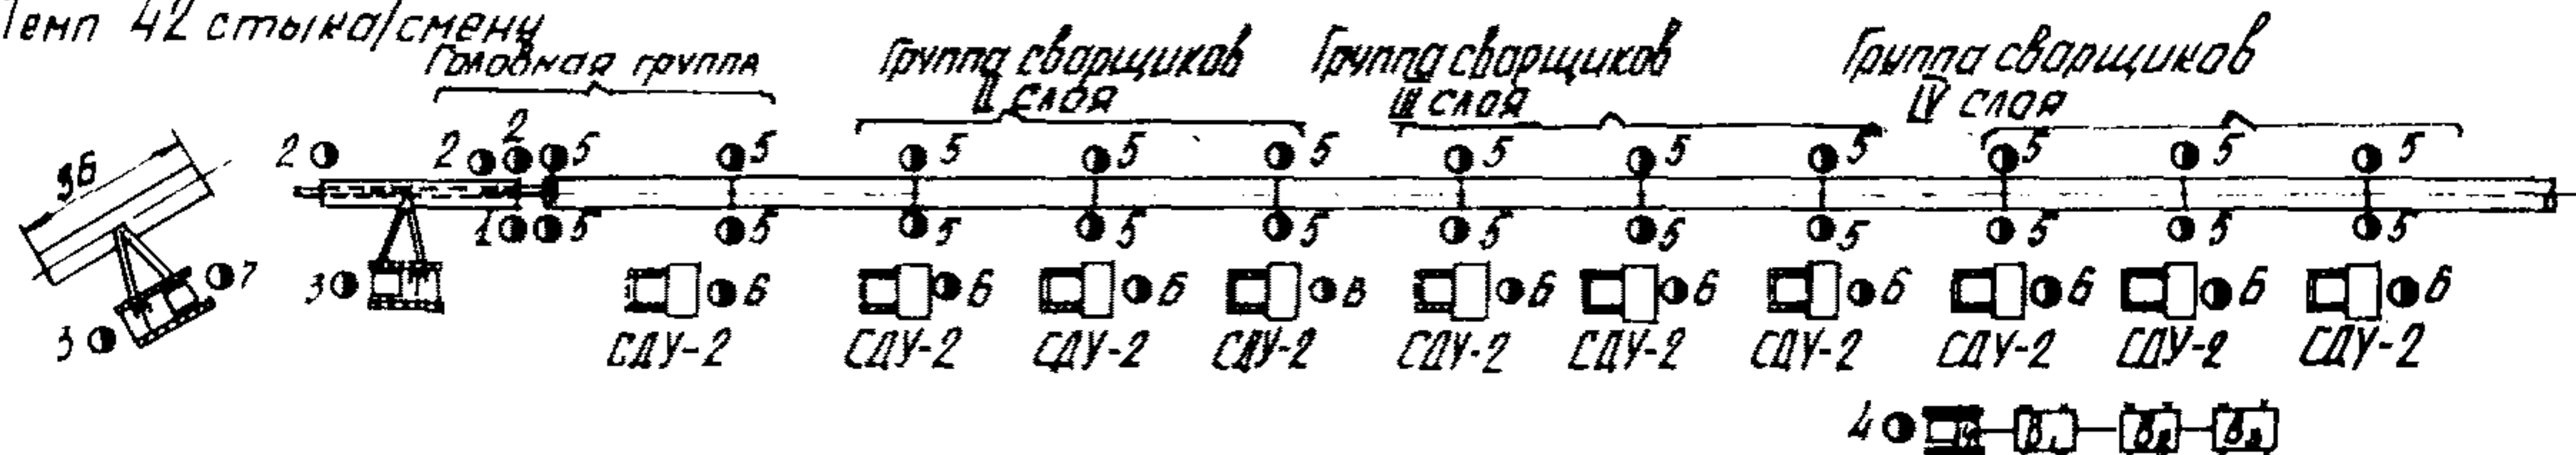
Схема поточно-группового метода сборки и сварки стыков труб диаметром 1220 мм:
